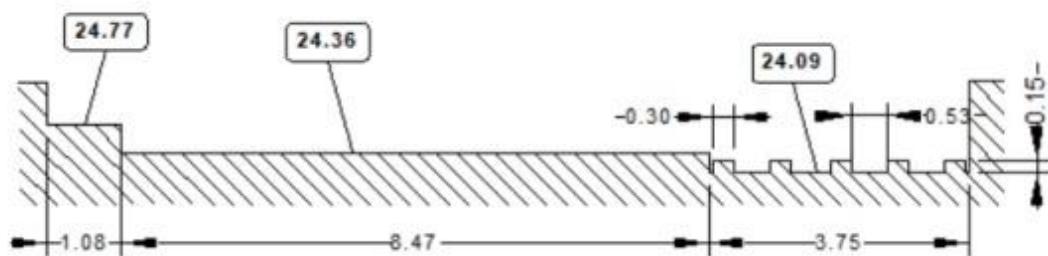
Coupe en travers de l'ouvrage des Égrilleux (source : MN'EAU)
